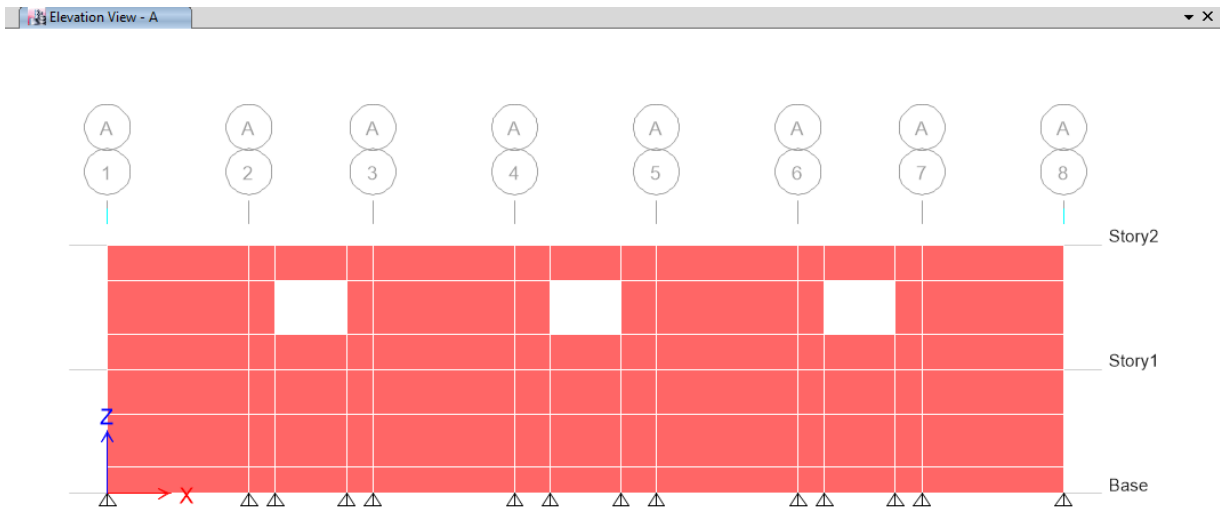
Vista en Elevación del Eje A del Edificio.
